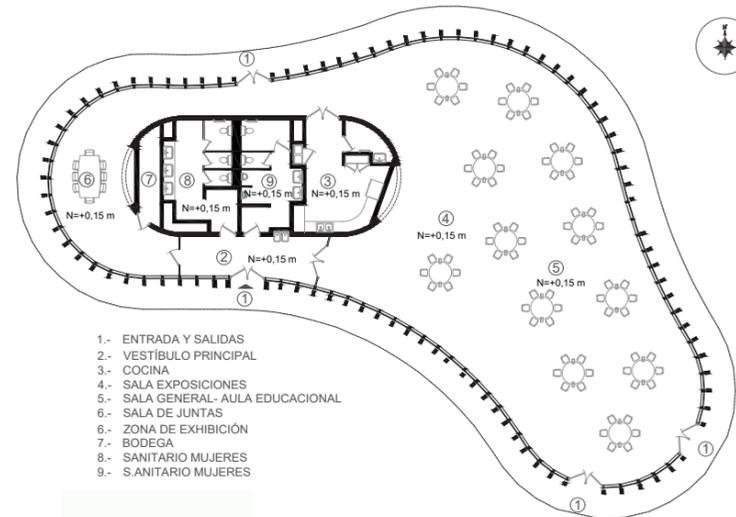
PLANTA DE ZONIFICACIÓN INTERIOR
